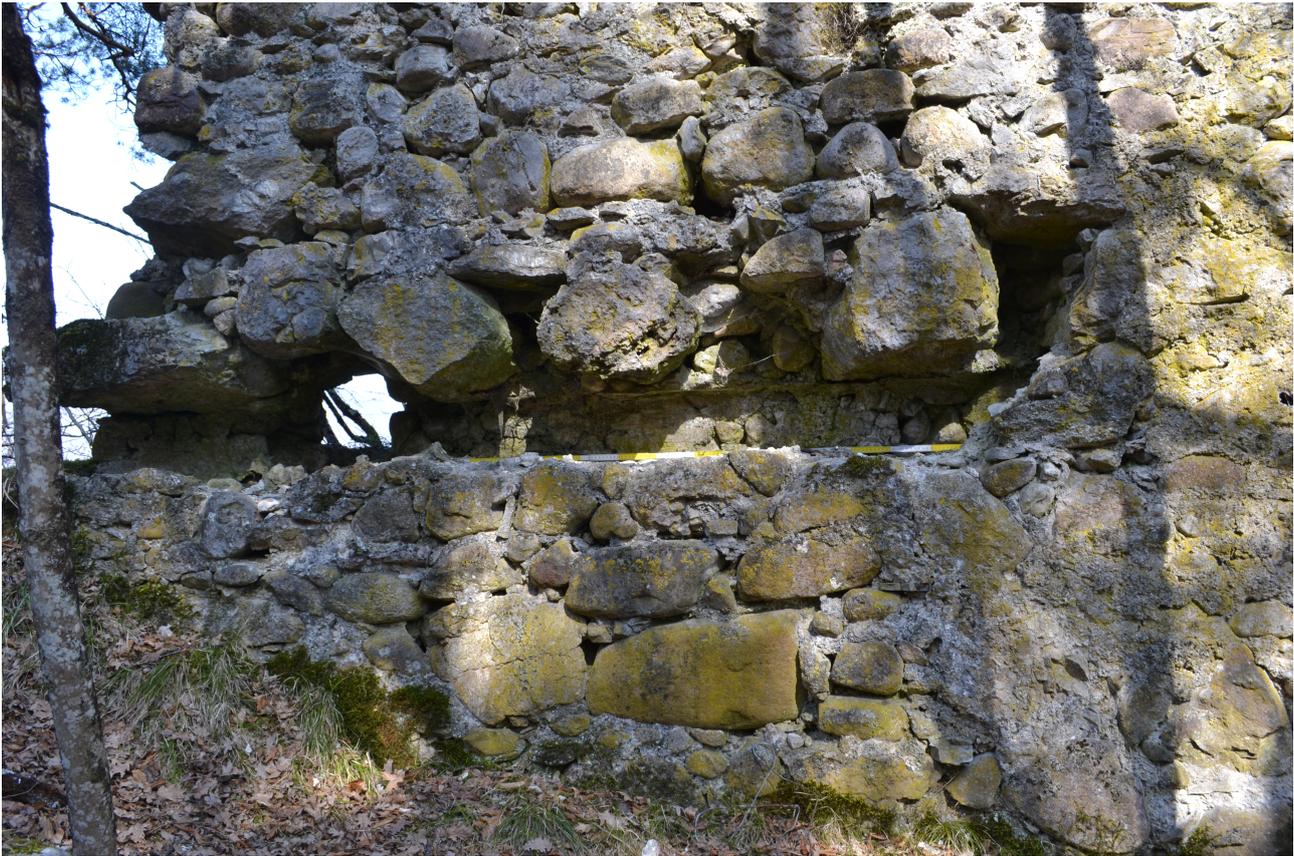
Castel Flavon, Flavon (TN). Prospetto del muro di cinta dove permane traccia di una trave a sezione rettangolare disposta longitudinalmente alla sezione.
